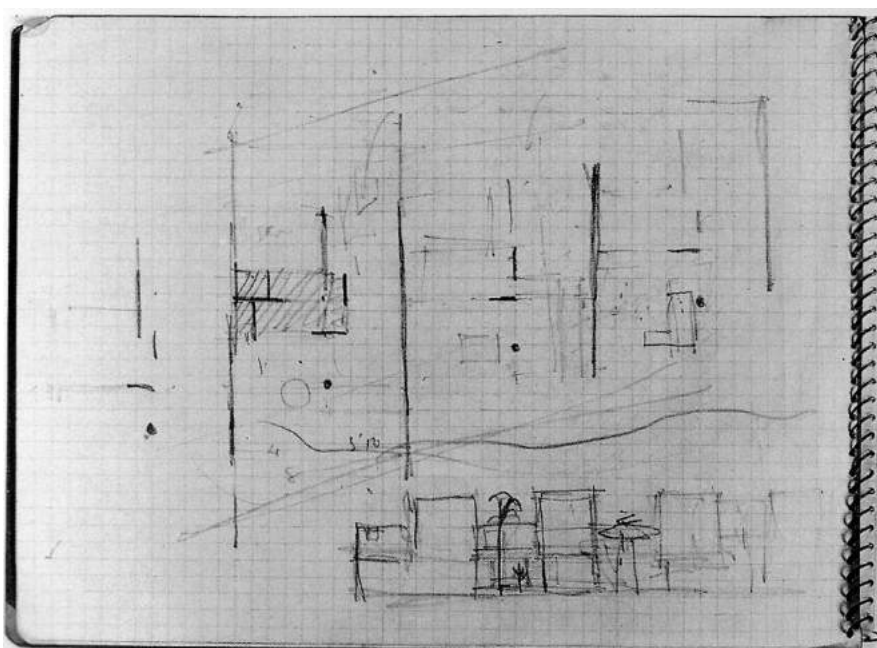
Esbozo de ordenación en planta y alzado, con el escalonamiento y ritmo seriado de las 4 viviendas (h.1954-55).
